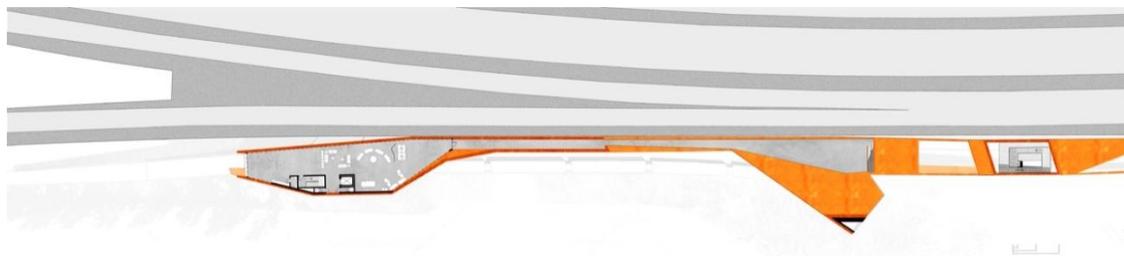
Coupe sur les ateliers de 2^e et 3^e niveaux
